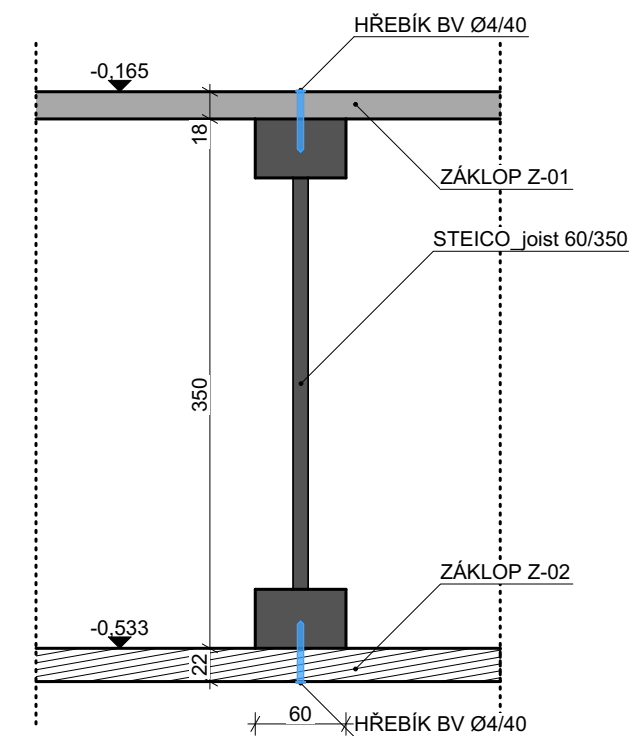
KOTVENÍ PŘÍČNÉ STĚNY K ZÁKLADOVÉMU ROŠTU
